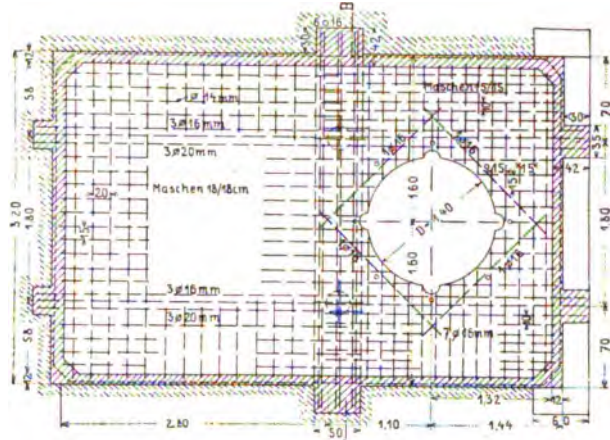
Turbinenanlage in Lauterbach, Grundriß.
